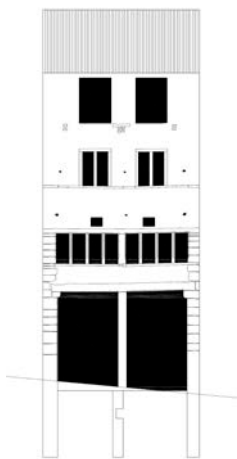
Basel, Haus „zum Wildenstein“ (Spalenberg 18). Rekonstruktion der Strassenfassade des Doppelhauses mit hohem Erdgeschoss-Zugang und Rauchlöchern über den Stuben im ersten Obergeschoss.
